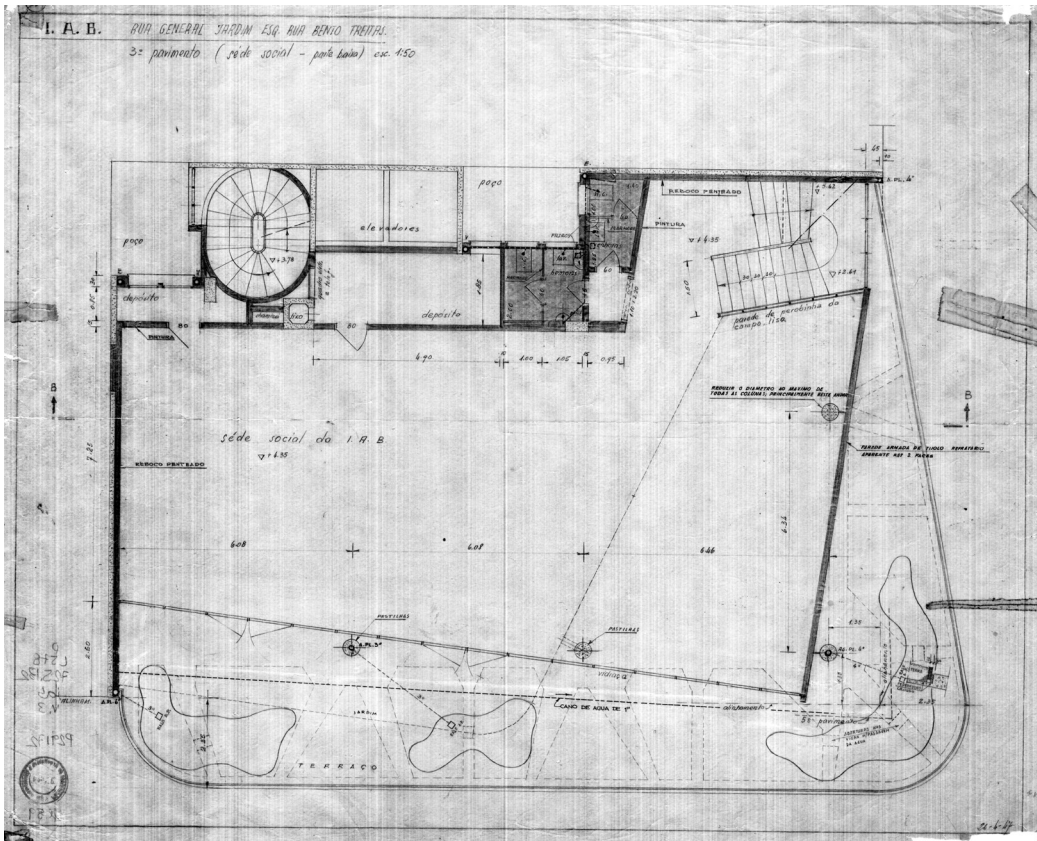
Projeto executivo original - Planta do Terceiro Pavimento - 1:200
